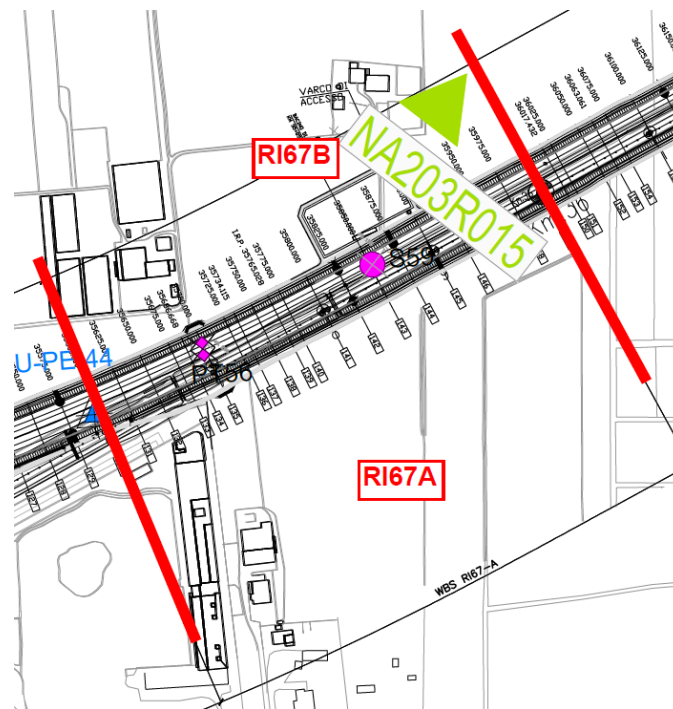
Planimetria Rilevato RI67B, estratto dalla Planimetria Generale (Doc. Rif. [5])
